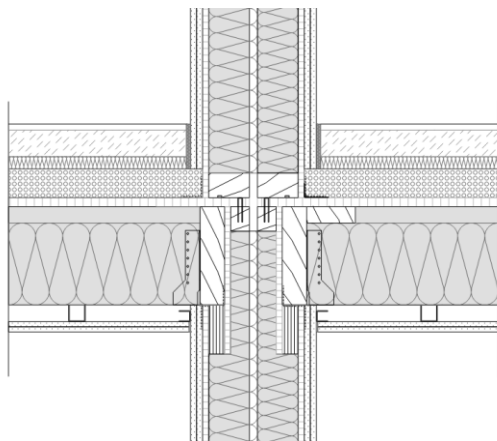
Detailplanung - Vertikalschnitt Wohnungstrennwand in Holzrahmenbauweise im Geschossübergang. Die Holz balkendecke spannt quer zur tragenden Wohnungstrennwand. Die flankierende Übertragung über die Decke ist im Holzbau immer spezifisch zu beurteilen, da diese maßgeblich das bewertete Schalldämm-Maß der Wohnungstrennwand beeinflusst.
